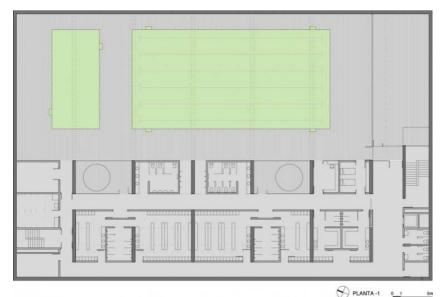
Planta arquitectónica baja. Fuente: http://www.archdaily.mx/70802/
